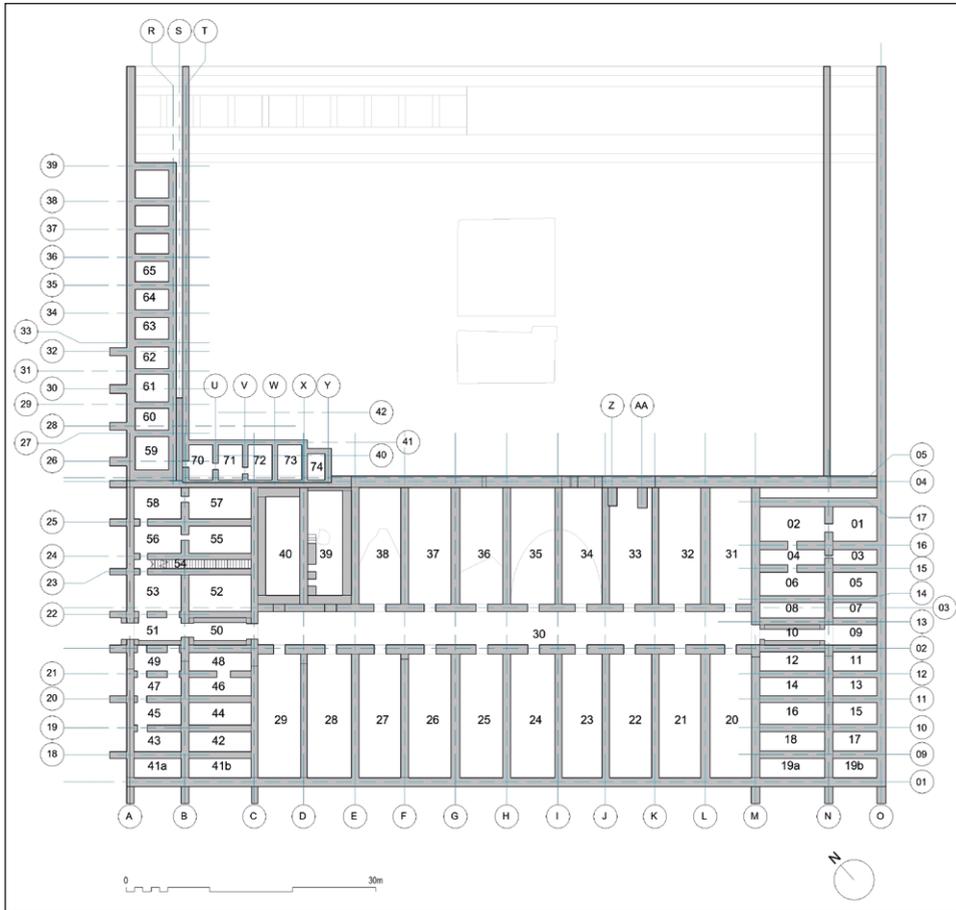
Planta del santuario. Sistema de referencia utilizado para los elementos constructivos y espacios.
